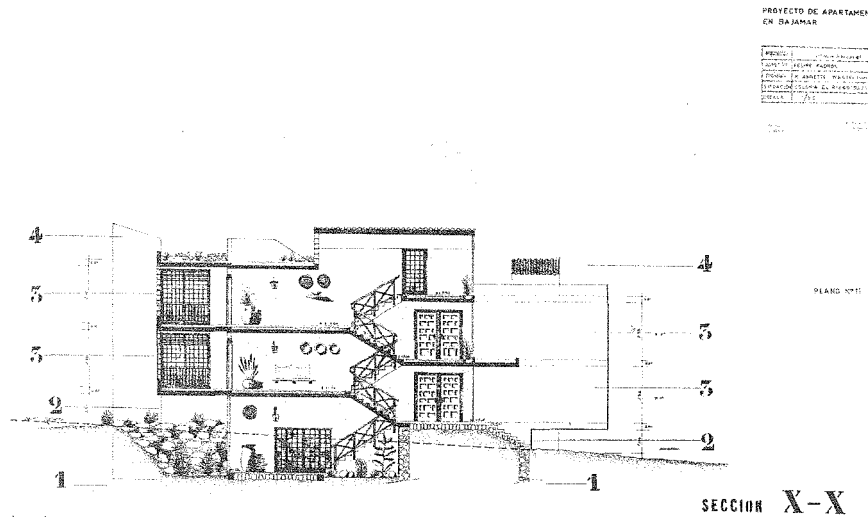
S. Fábregas, Plano n.º 11. Sección. Proyecto de apartamentos en Bajamar, Tenerife, 1963 (Archivo Fábregas).
